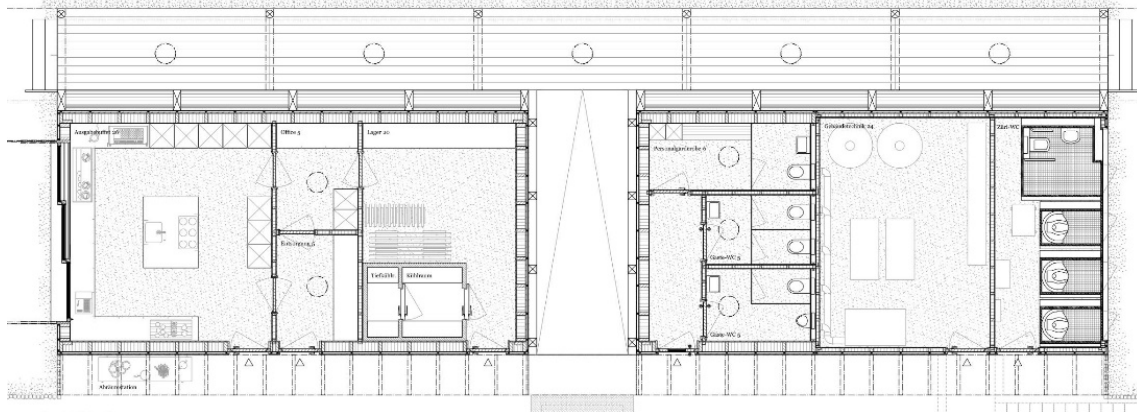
Grundriss Kioskgebäude; ARGE Schmid Kuhn Landschaftsarchitekten, Zürich und Loeliger Strub Architektur GmbH, Zürich
